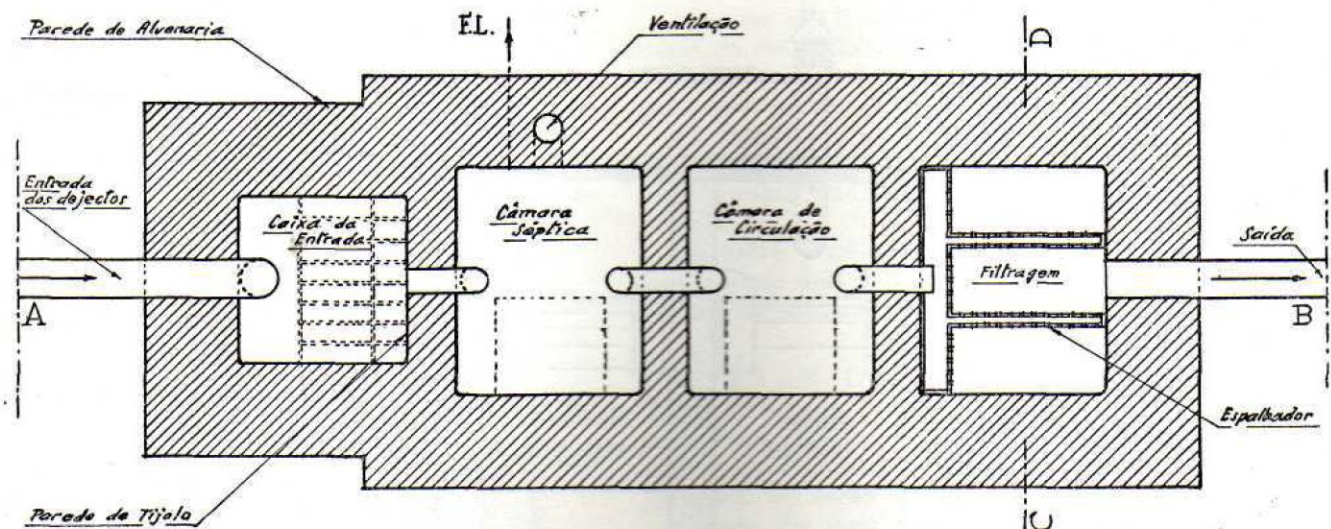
PLANTA DE UMA FOSSA SÉPTICA
